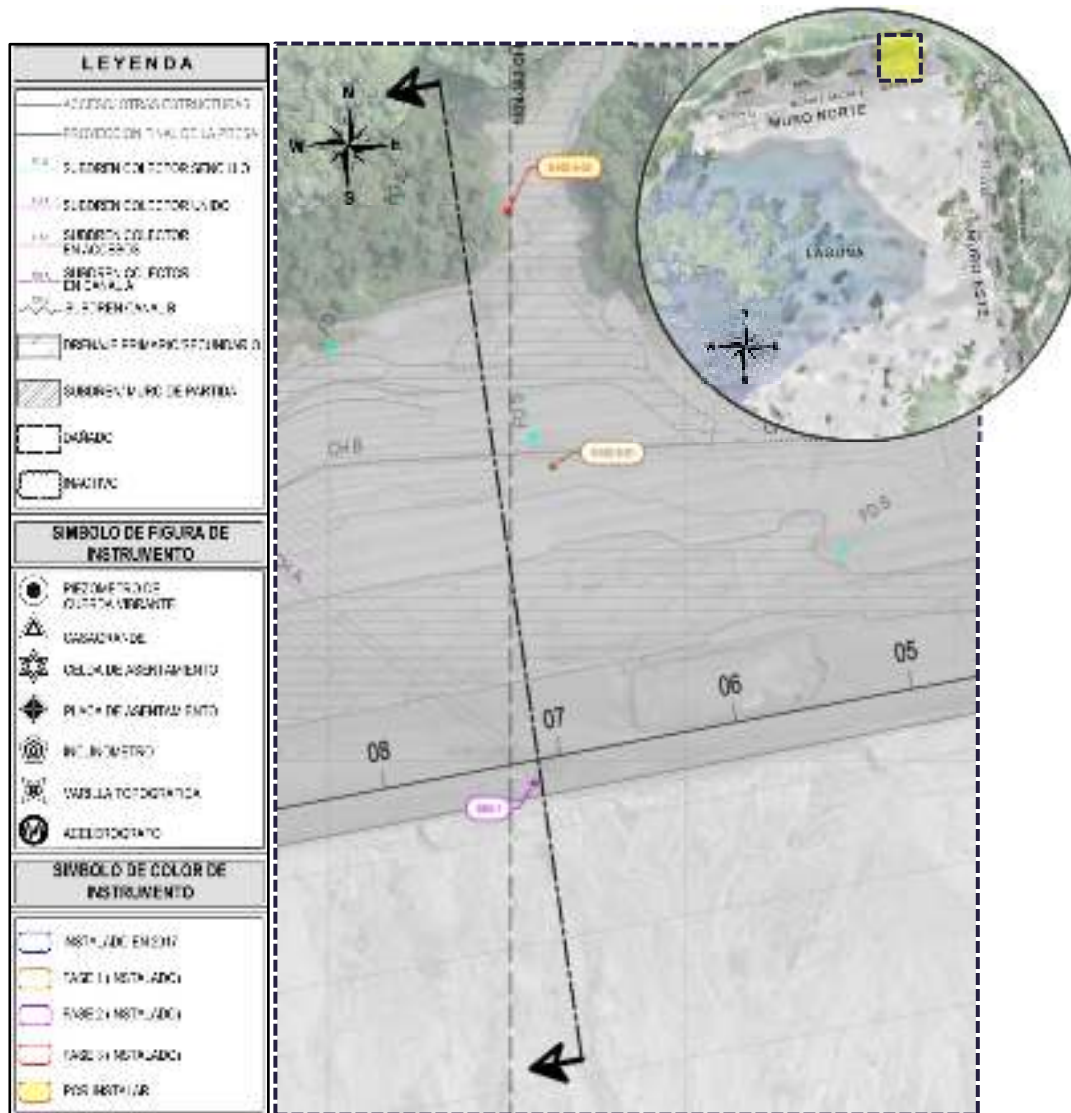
Vista de Planta en el Muro Norte Sector 1 con las Celdas de Asentamiento
